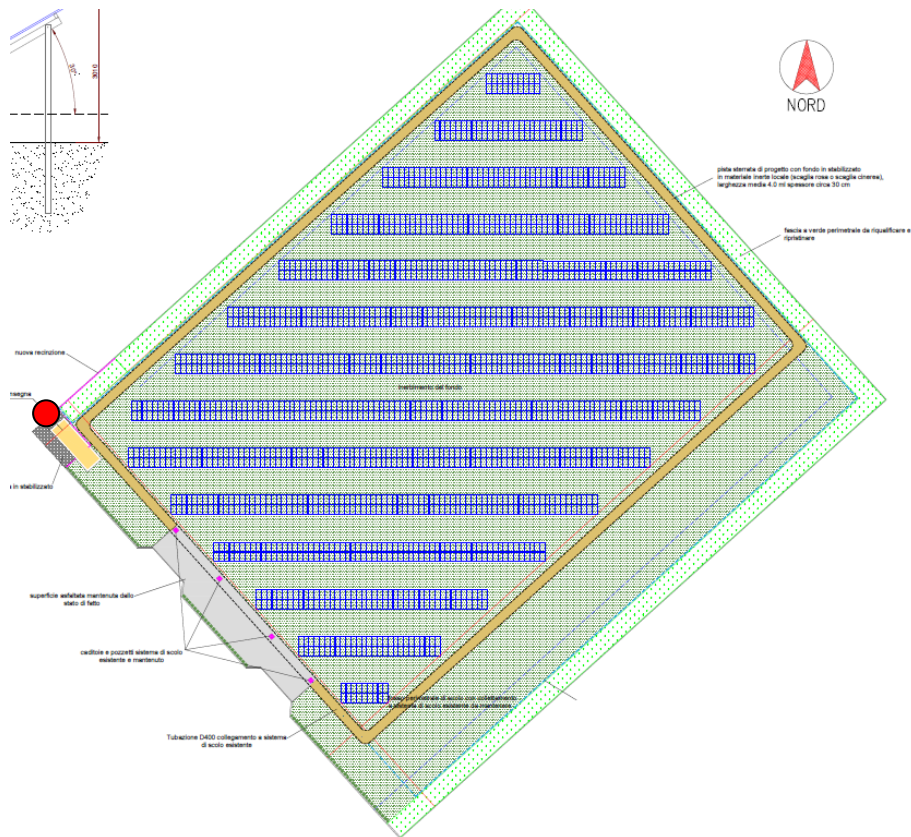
layout progettuale e punto di consegna (in rosso)
